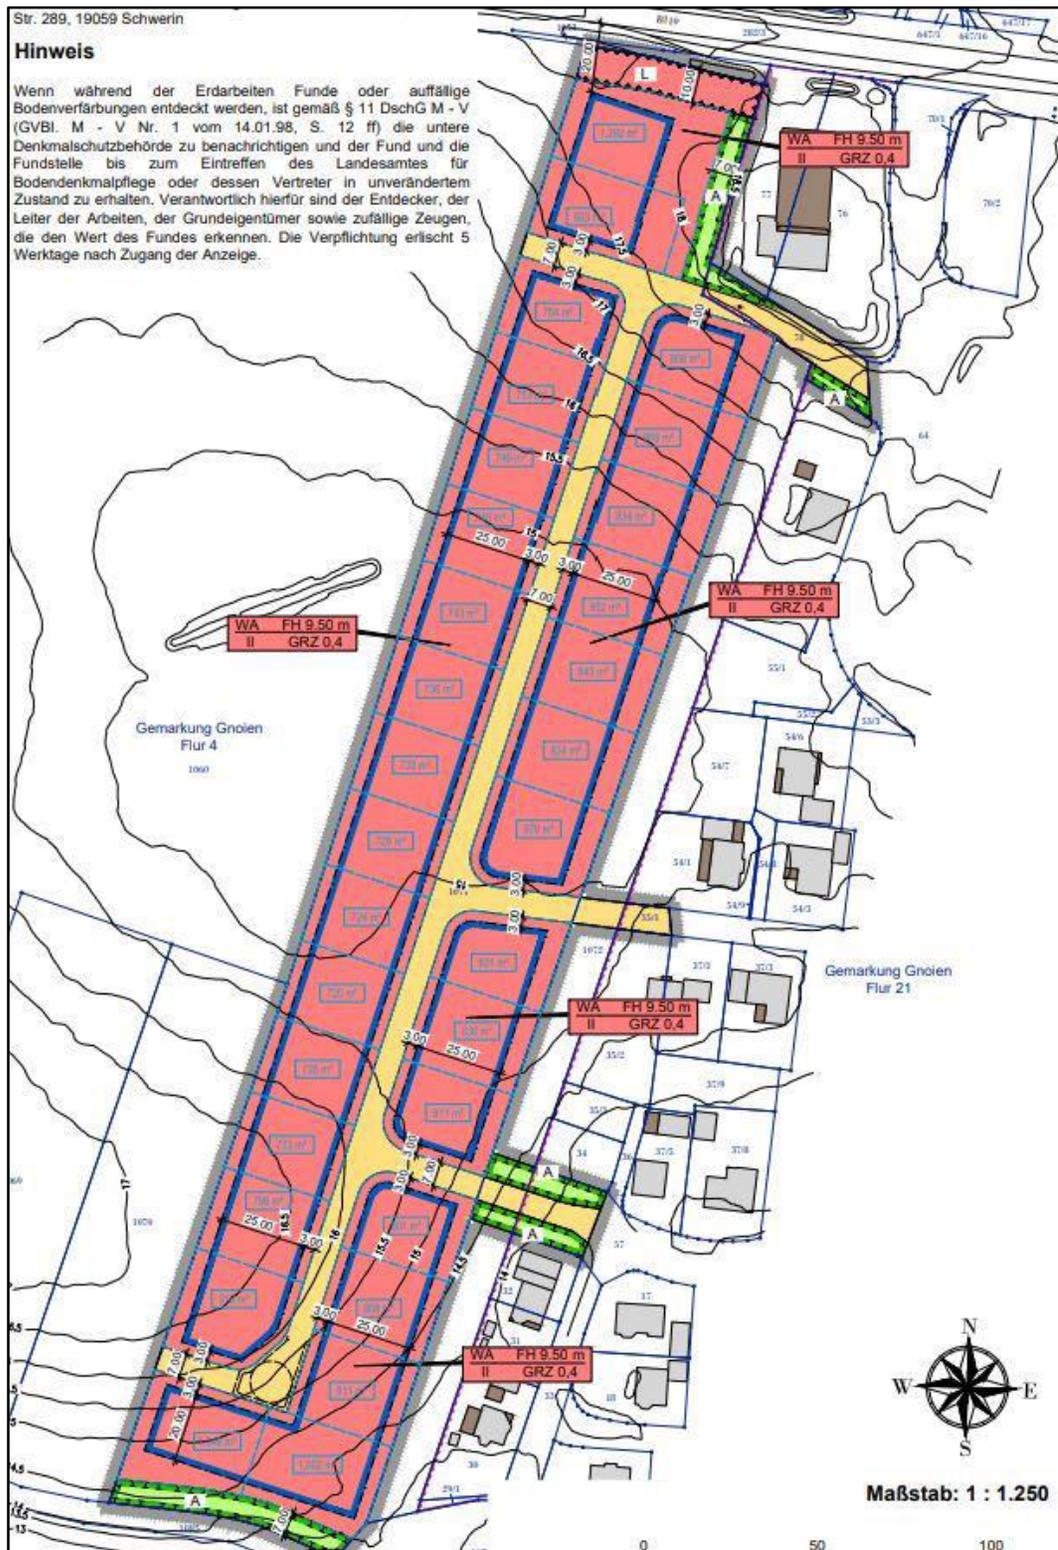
Planzeichnung des Bebauungsplans „Wohngelände Warbelblick“
